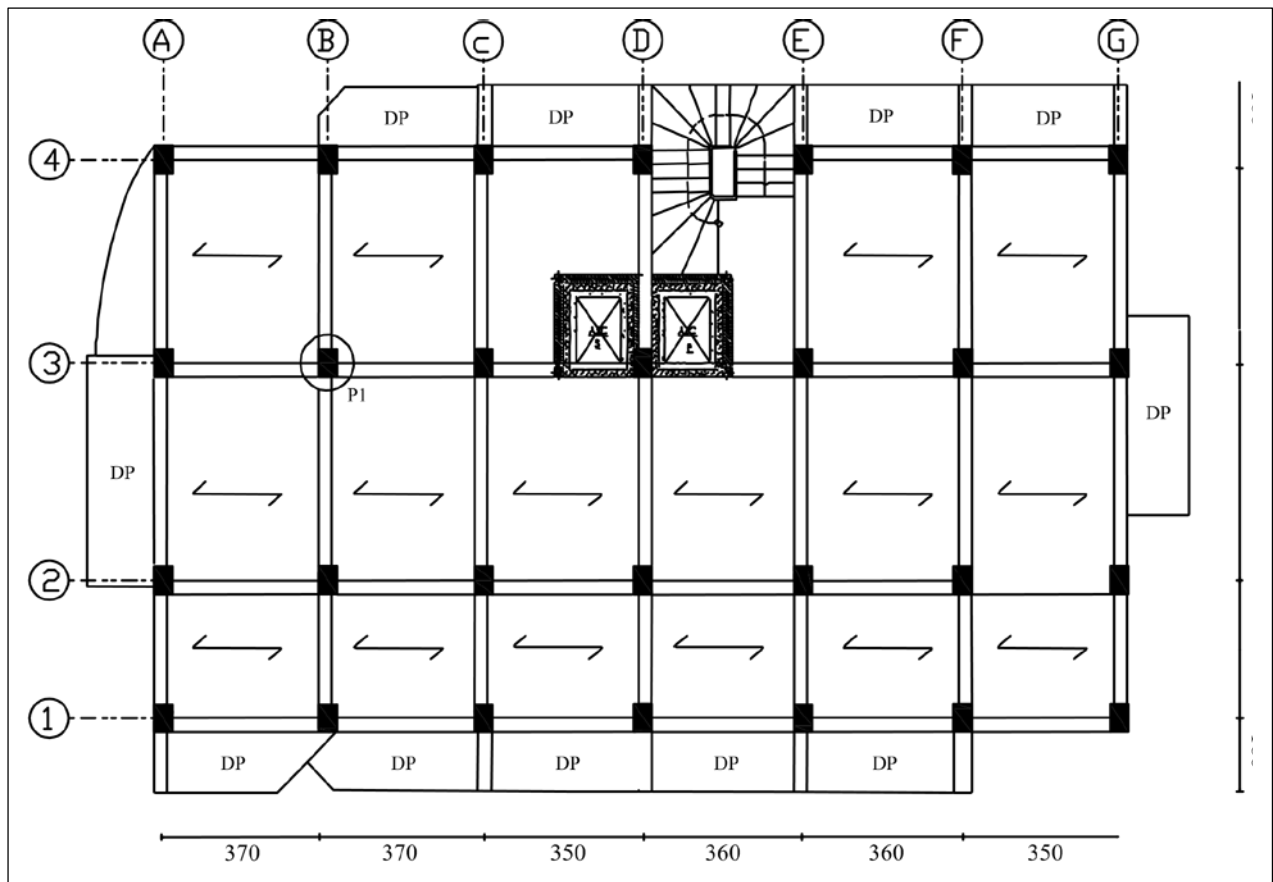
Disposition des poutrelles au niveau d'étage courant.
